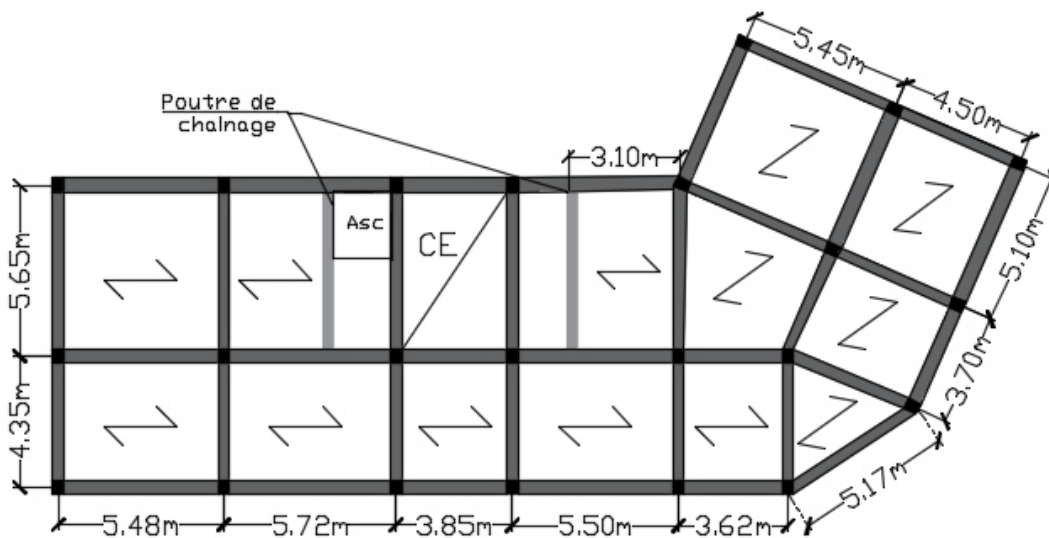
Schéma de disposition des poutrelles du plancher RDC.
